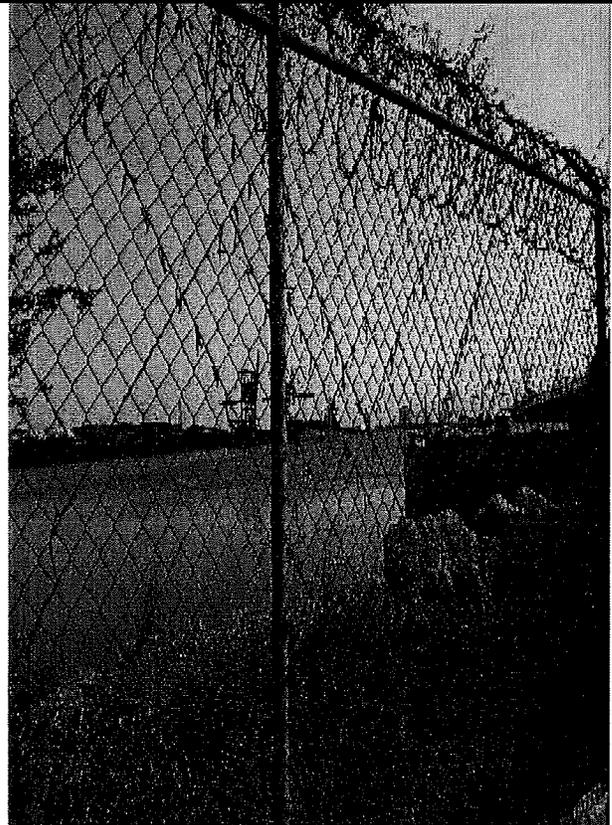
Otra vista del Canal suroeste, donde también se se contemplan actividades de dragado para su ampliación.
